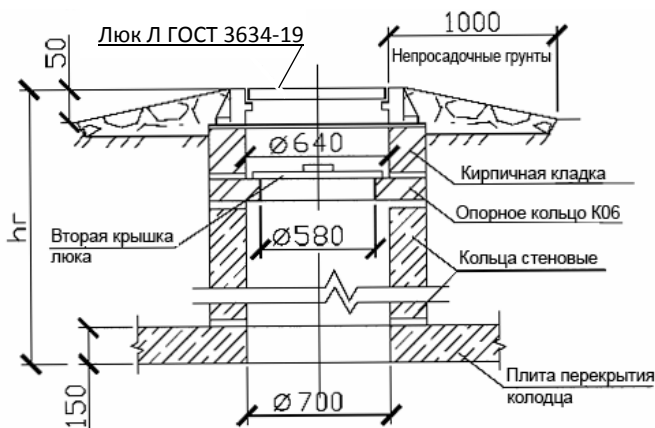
Горловина колодца для временной нагрузки 4.9 кПа
